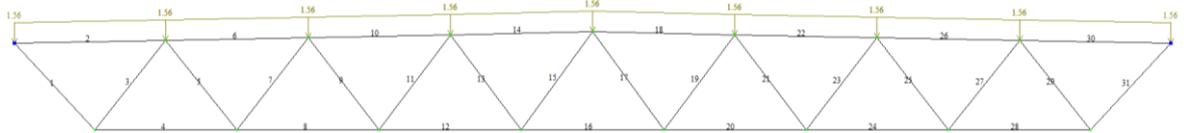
Загрузка 2, Нагрузка от веса покрытия
